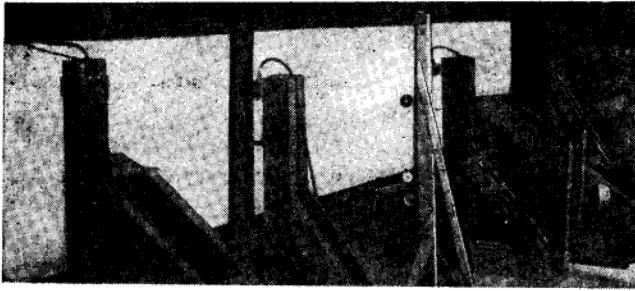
Испытание на косоу изгиб навесной стеновой панели с анкерными замоноличенными узлами опирания
